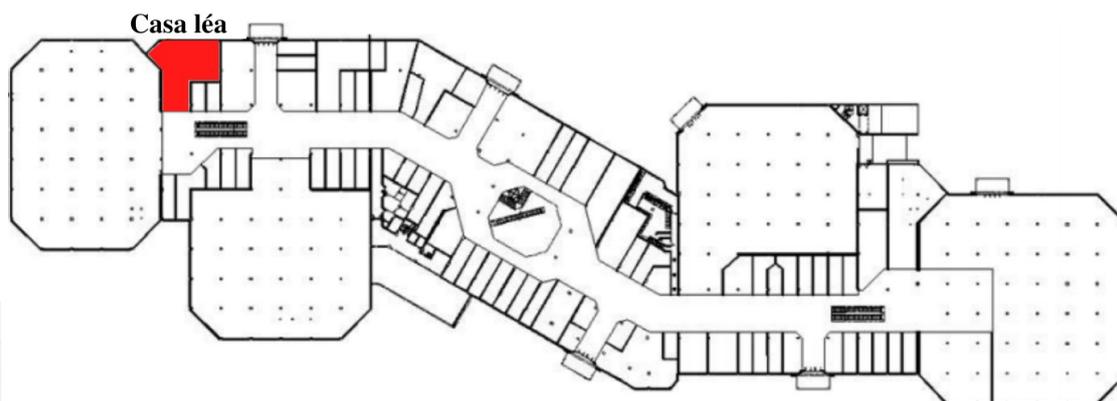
Planta do primeiro pavimento Maceió Shopping, com destaque para a localização da loja Casa Léa.
